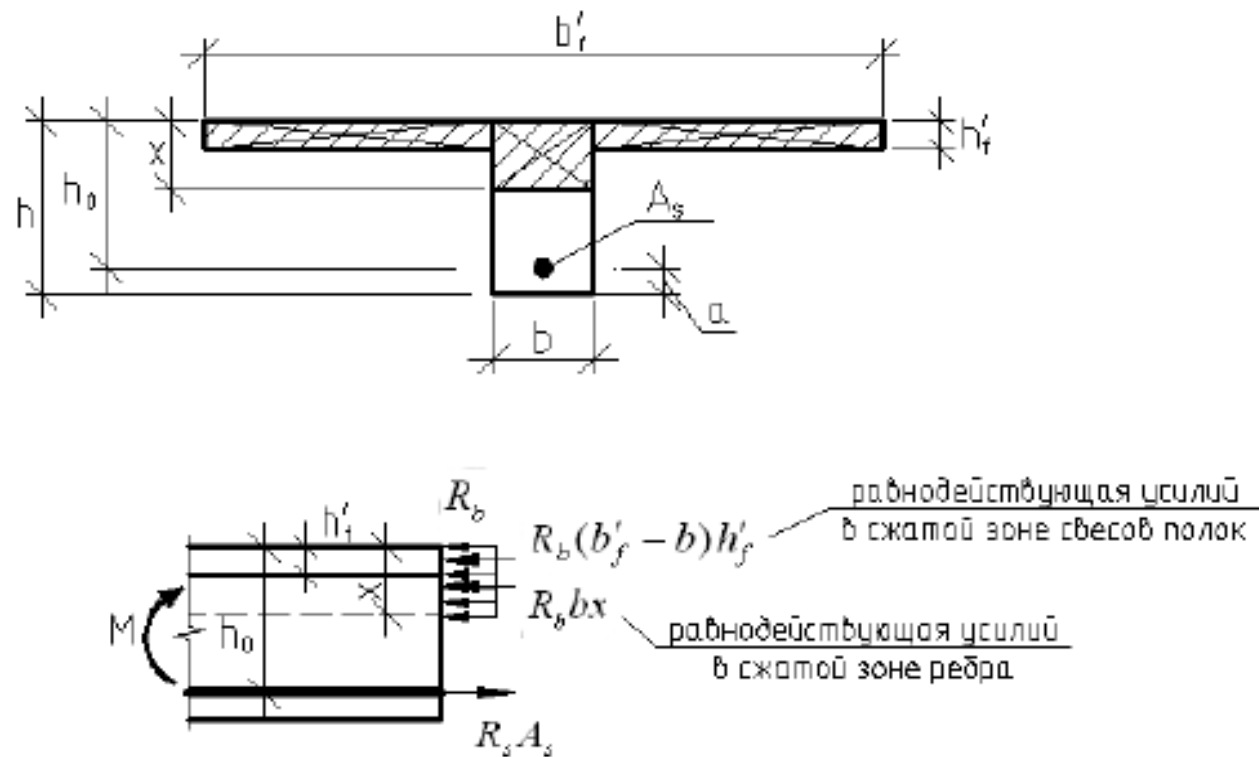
К расчету растянутой арматуры в элементах таврового профиля.
